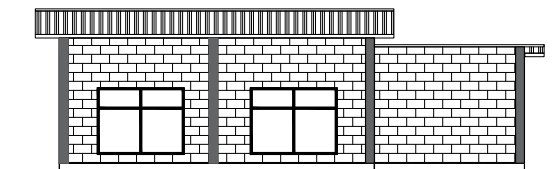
Fachada de vivienda unifamiliar de hormigón y bloque
